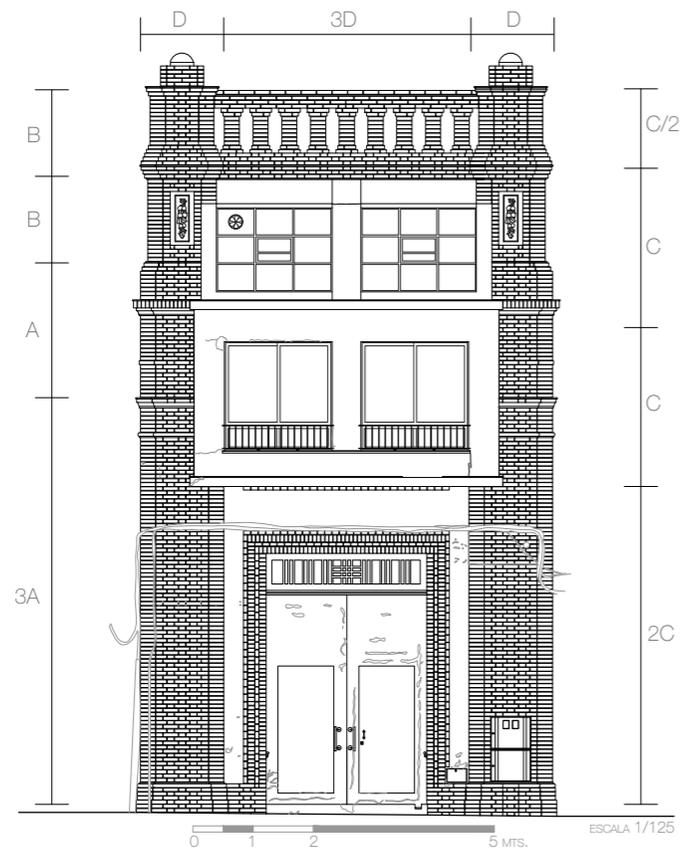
Alzado fachada estado actual. Fuente: Elaboración propia
